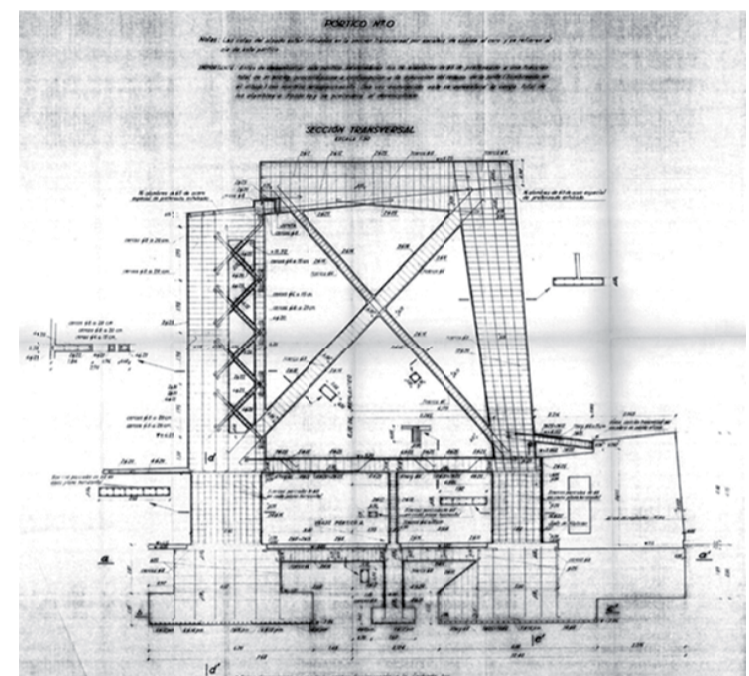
Pórtico 0 de Apoyo al Oeste. Las rótulas Freyssinet en pies y cabeza de Planta Baja permite considerarlo un apoyo deslizante.
